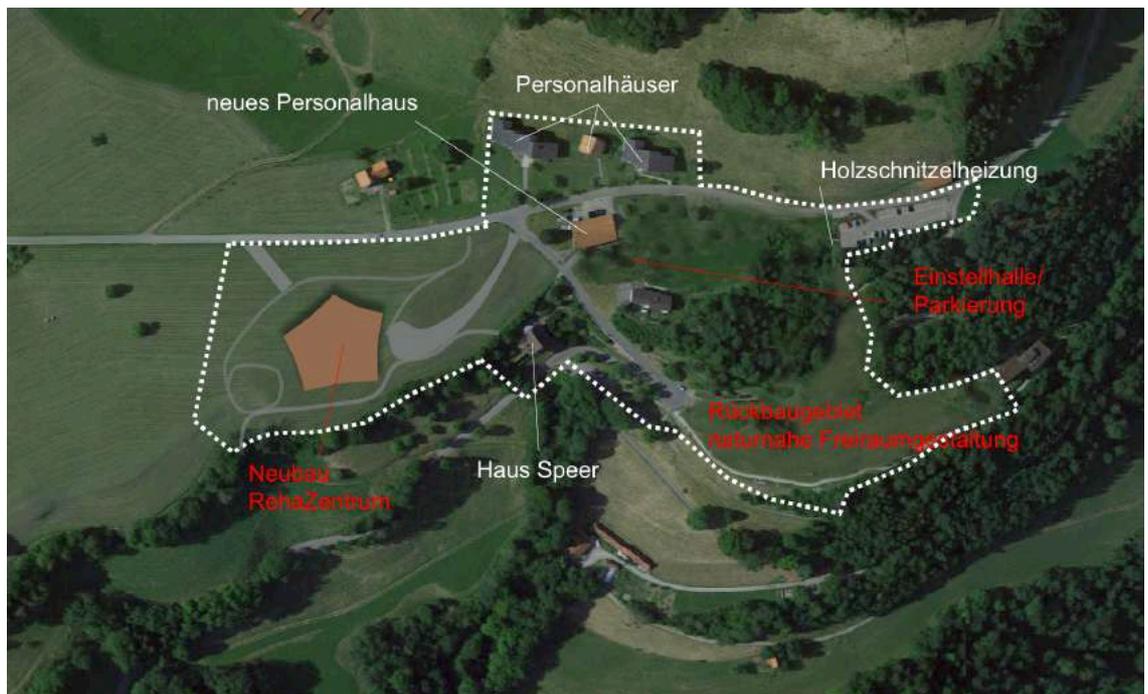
Schema geplante Situation (SKW 10.5.2023)
